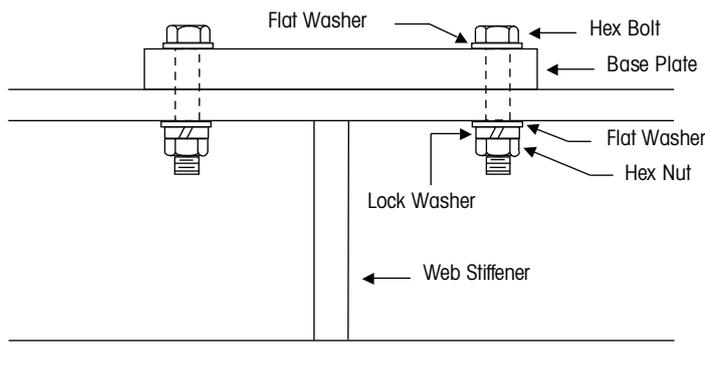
Plaque de base boulonnée à un support de poutrage
